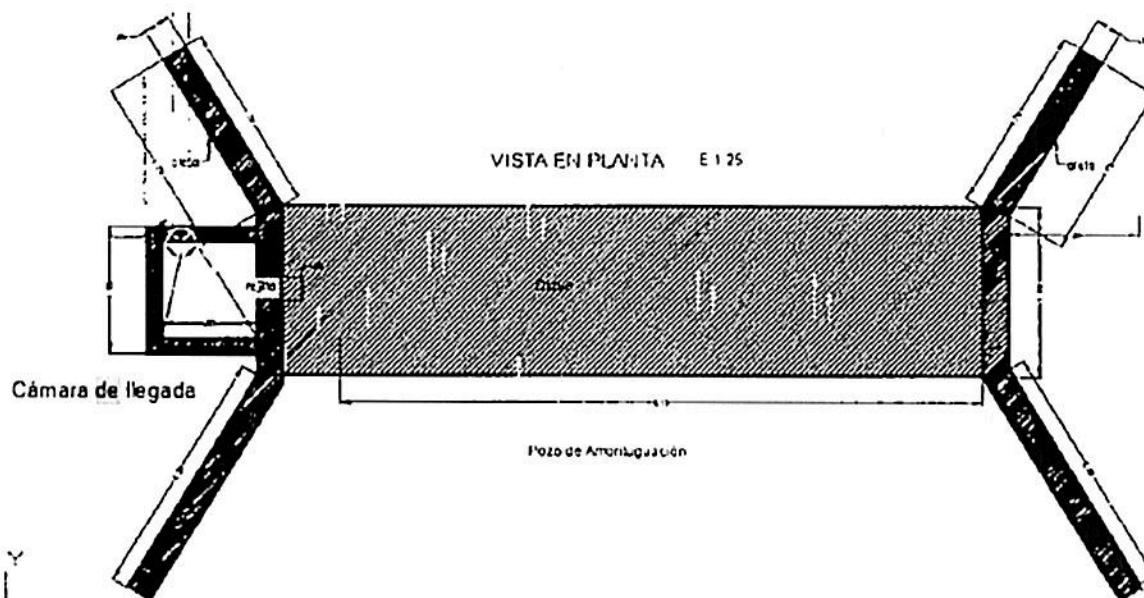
Bocatoma lateral vista en planta (Diseños presentados 2021)
